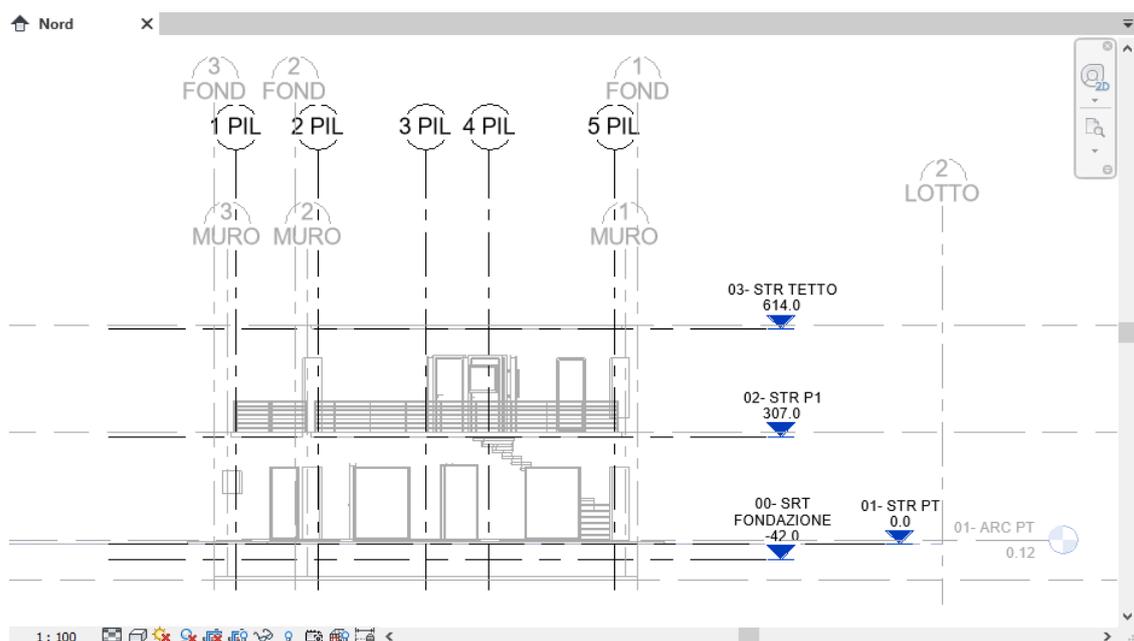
Vista Nord: Prospetto nord modello architettonico collegato in mezzi toni
